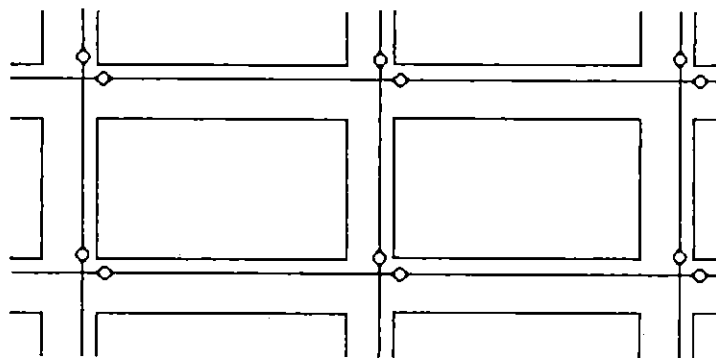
Instalación de las Válvulas de compuerta en las calles y avenidas.
